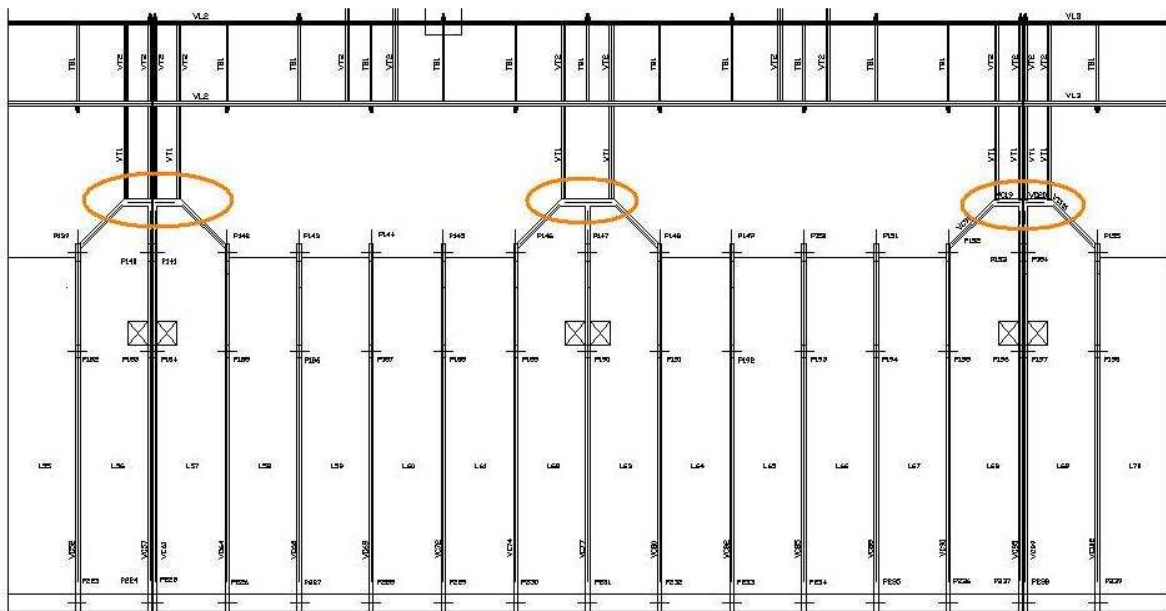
Plano geral da estrutura metálica da passarela, como também em destaque as regiões onde estão ocorrendo fissuras (CEPLAN - UnB, 2009)
